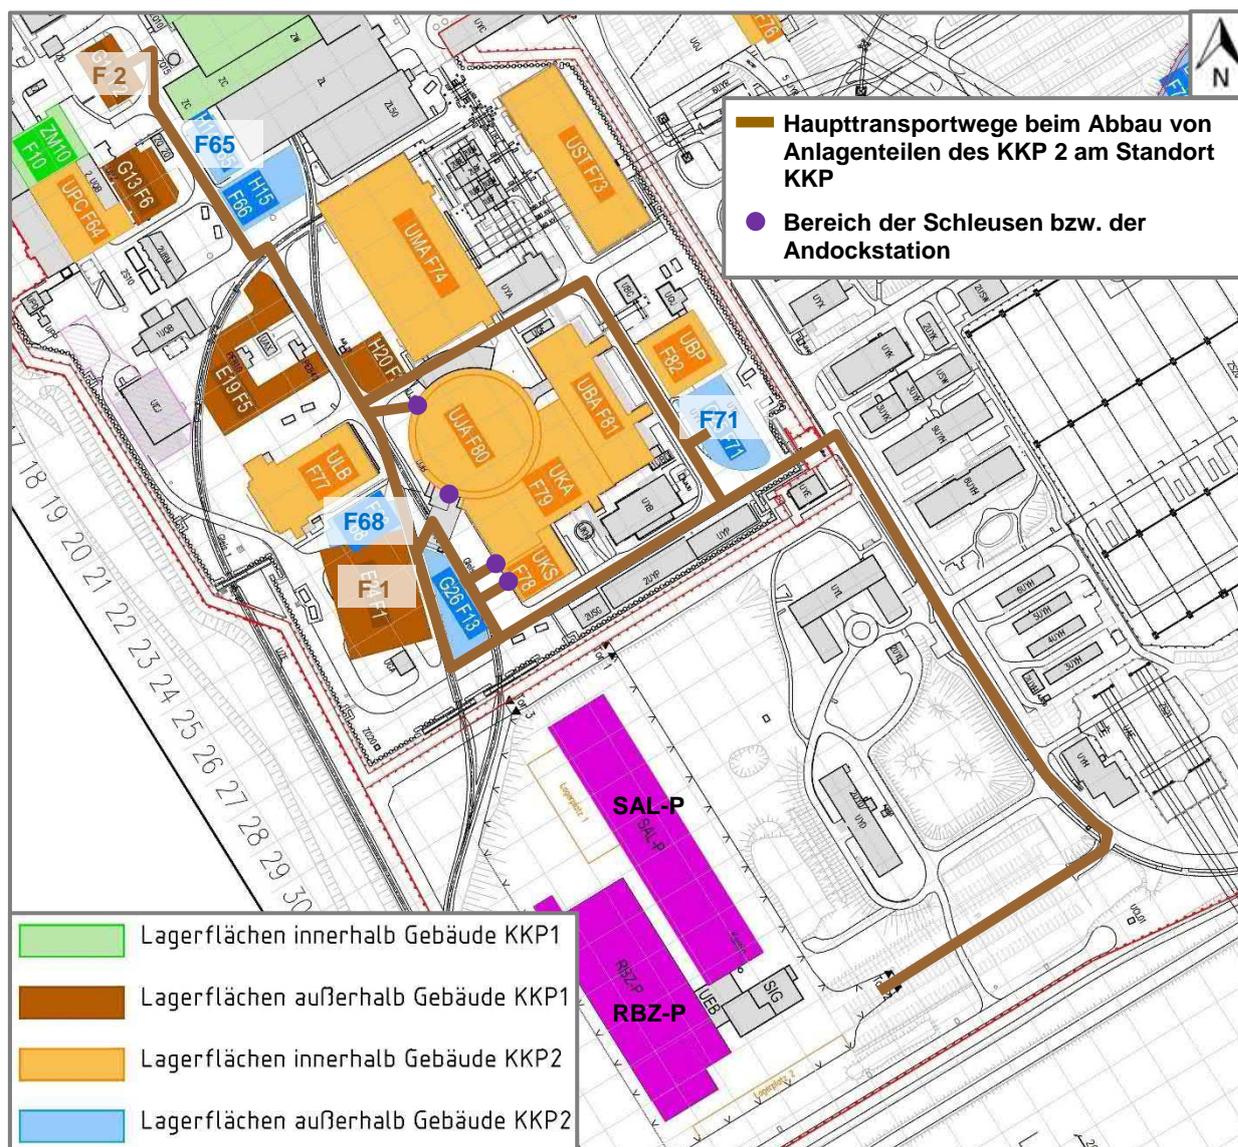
Lagerflächen, Haupttransportwege und Bereiche mit Schleusen bzw. Andockstation
